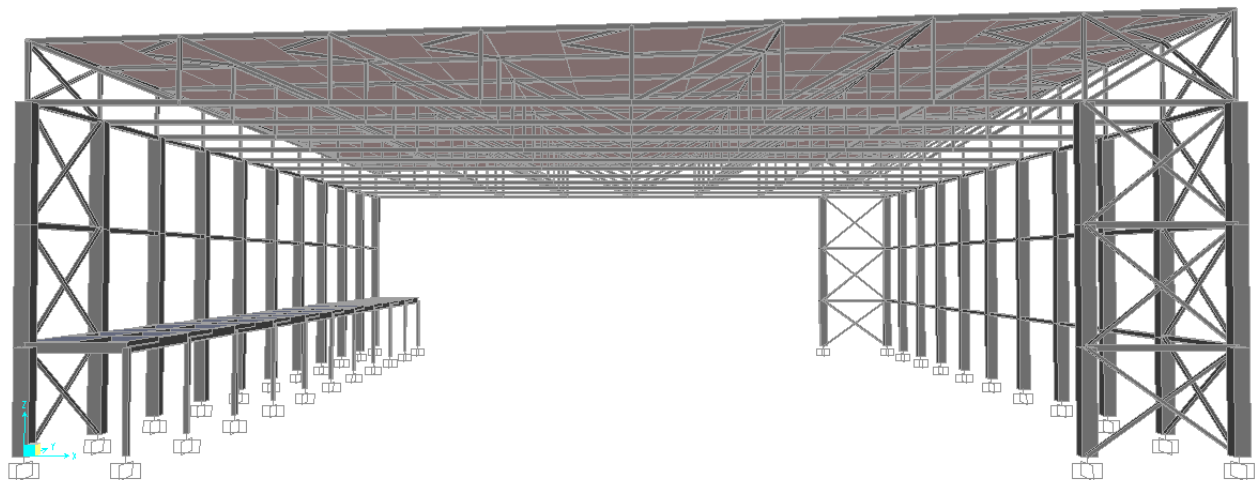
BLOQUE III – VISTA EXTRUIDA INFERIOR
